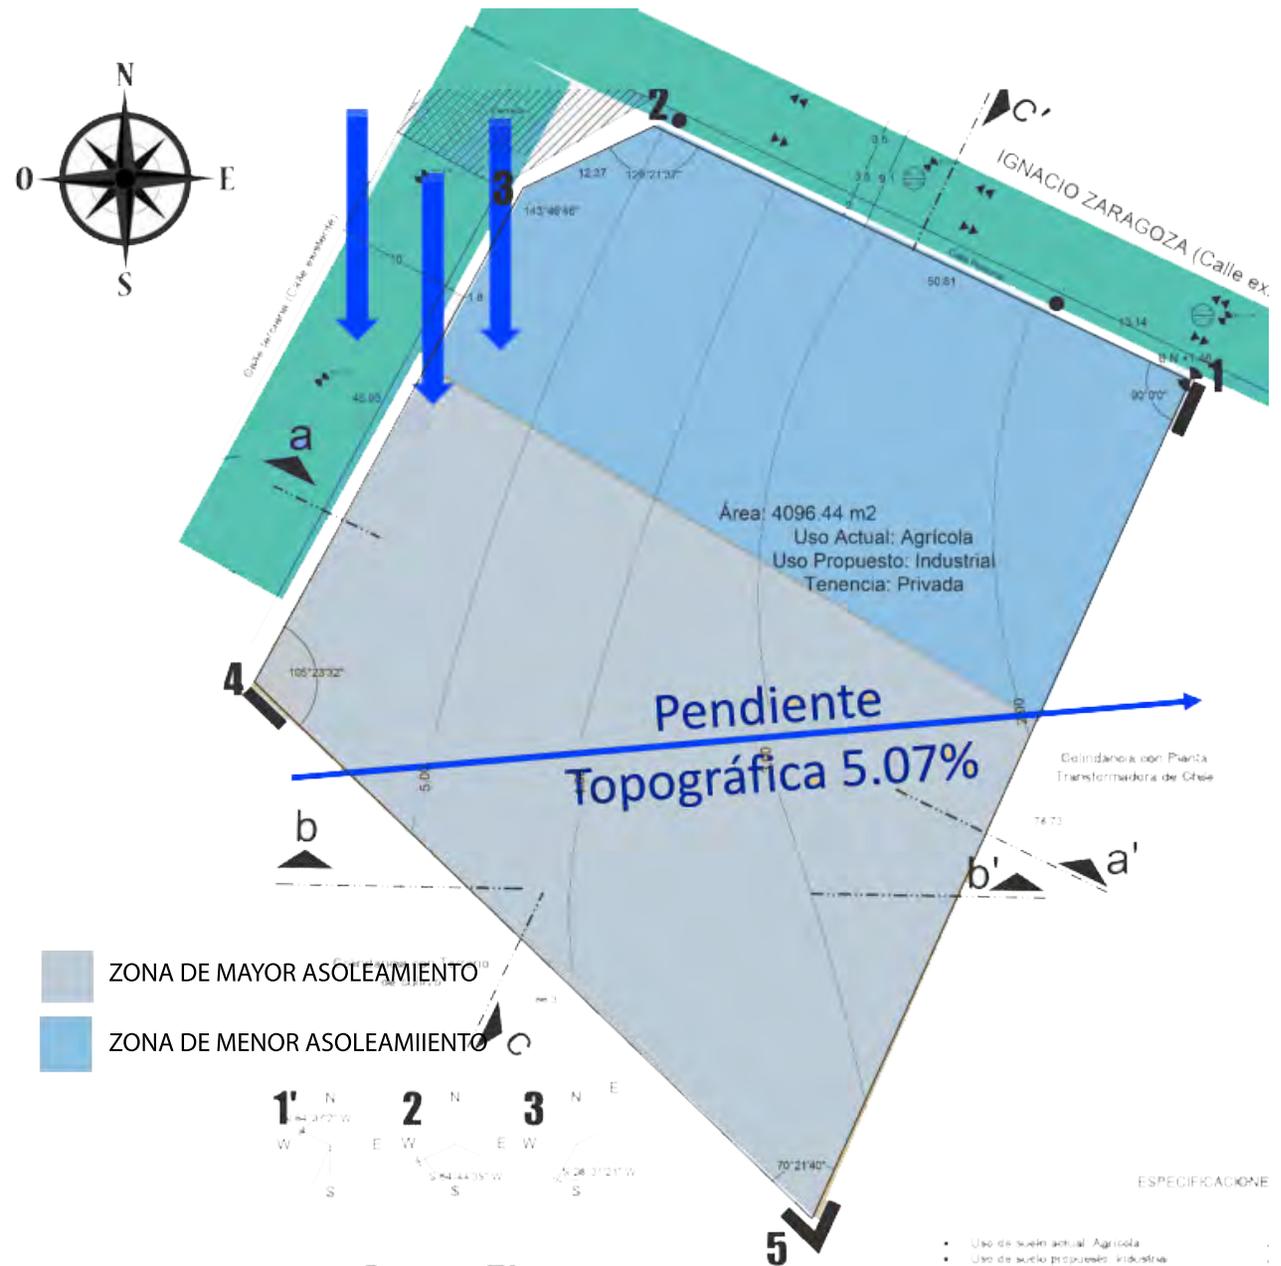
Terreno propuesto para emplazamiento de Planta procesadora de Lácteos
